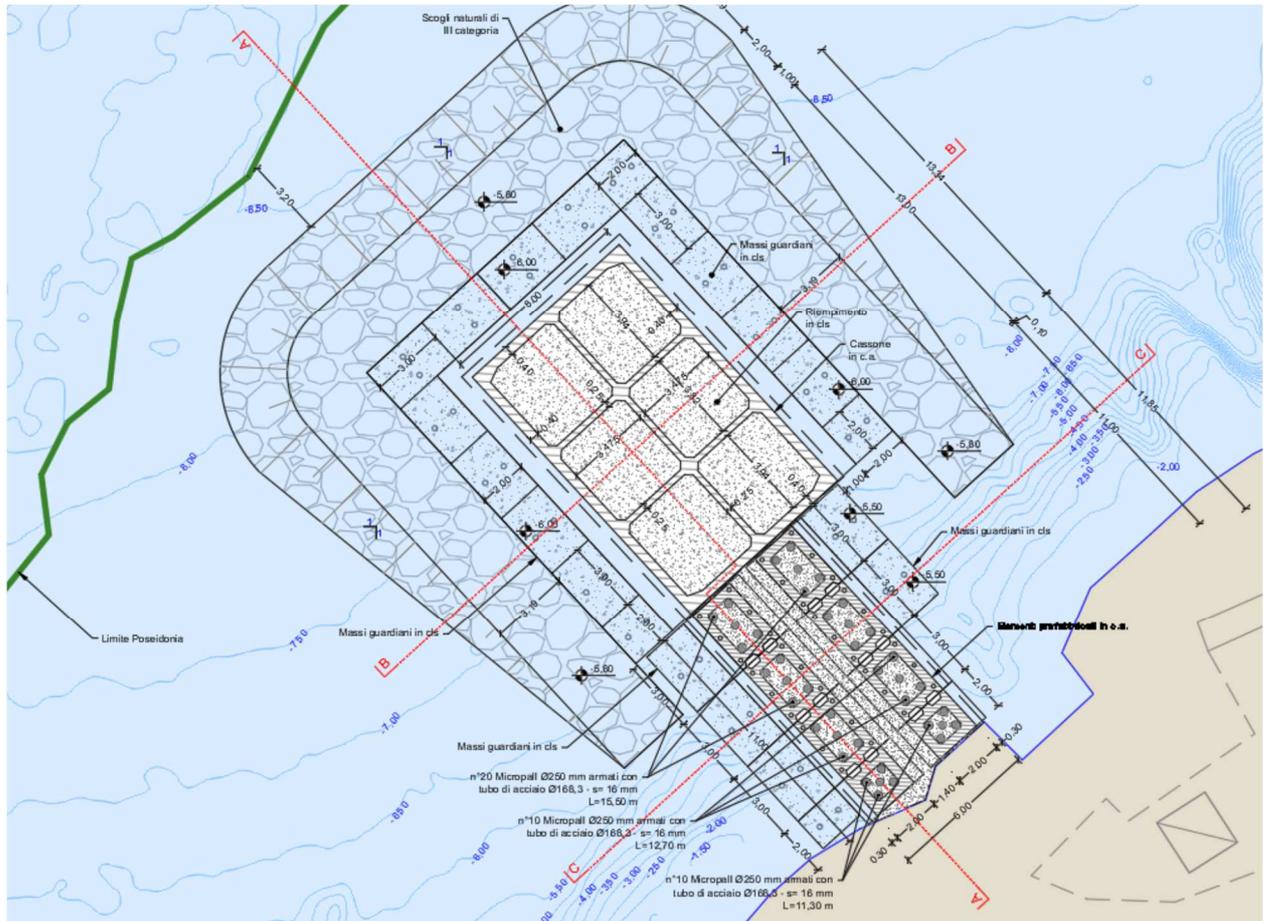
Planimetria costruttiva estratto da 2017E037INV-02-D-OM-TAV001
